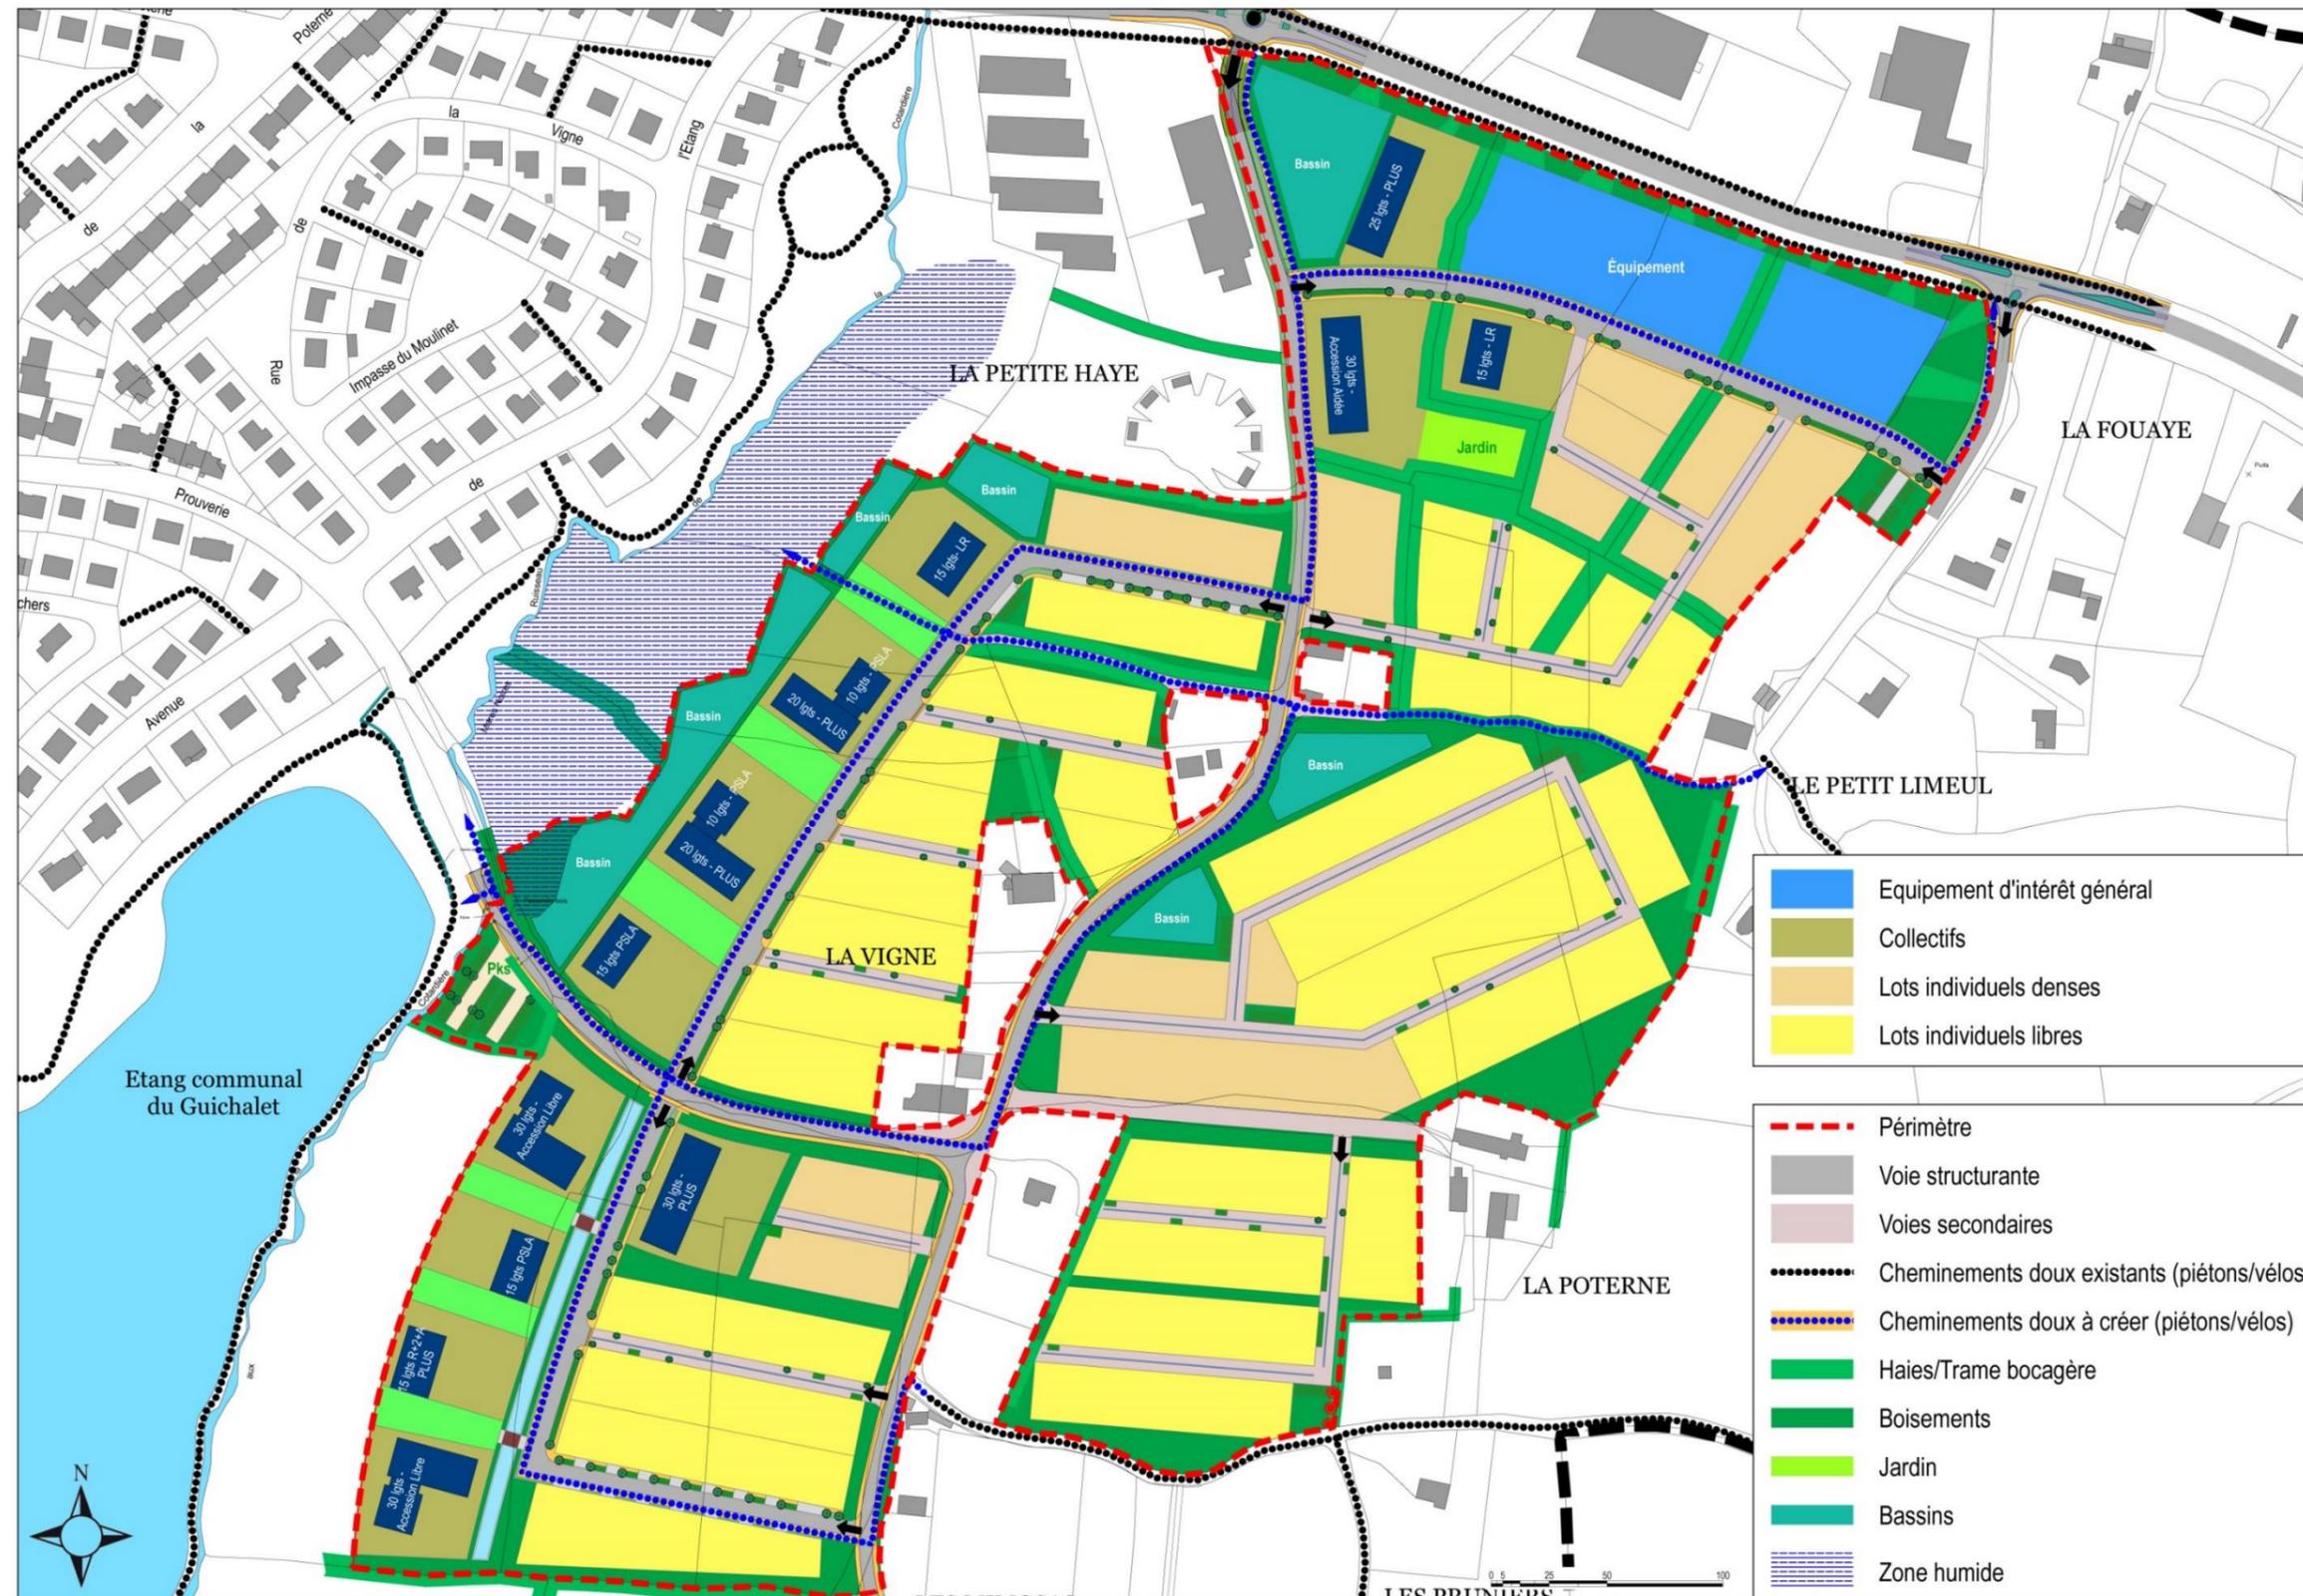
Plan de masse d'intention ZAC Multisites « Centre-ouest / La Vigne », Juillet 2019 (Source : ARCHIPOLE)
